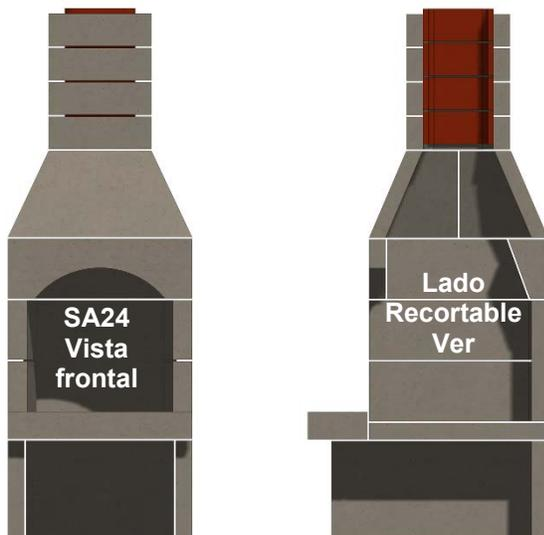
Montaje de la SA24 chimenea & Vista en corte
